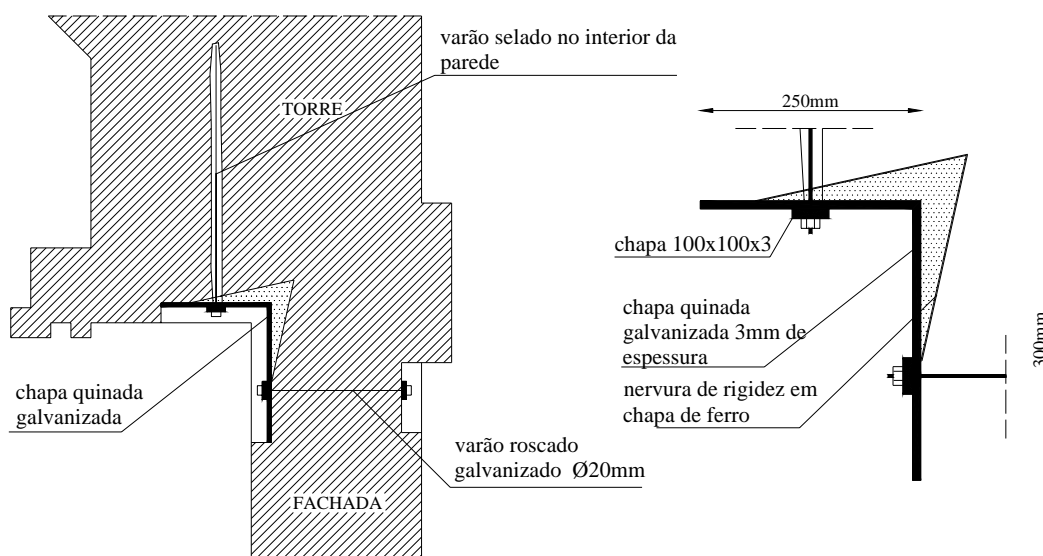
[4d]: a) Pormenor de ligação da chapa quinada à parede da torre e da fachada
